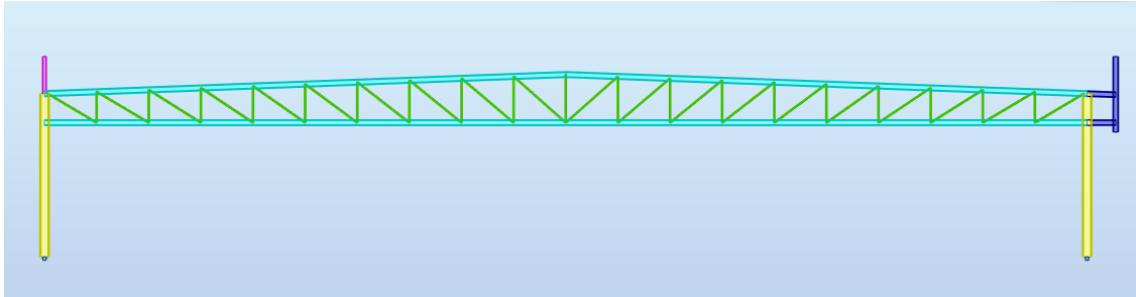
Layout preliminar do pórtico tipo (imagem capturada do ROBOT).
